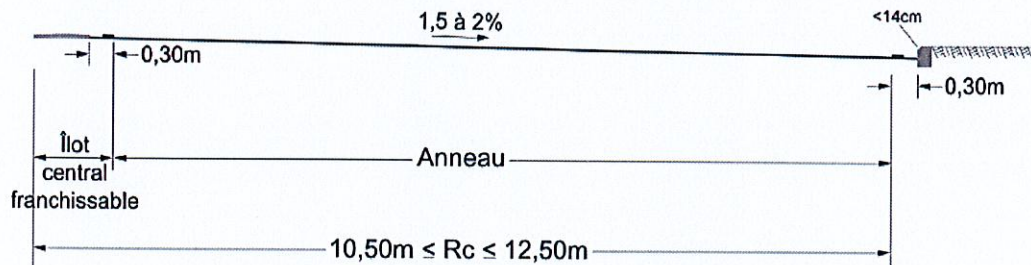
Profil en travers type de l'anneau du giratoire sans surlargeur
